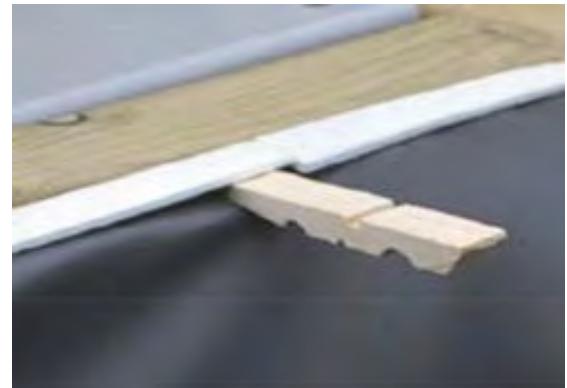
Bloccaggio del liner in posizione con mezze mollette
